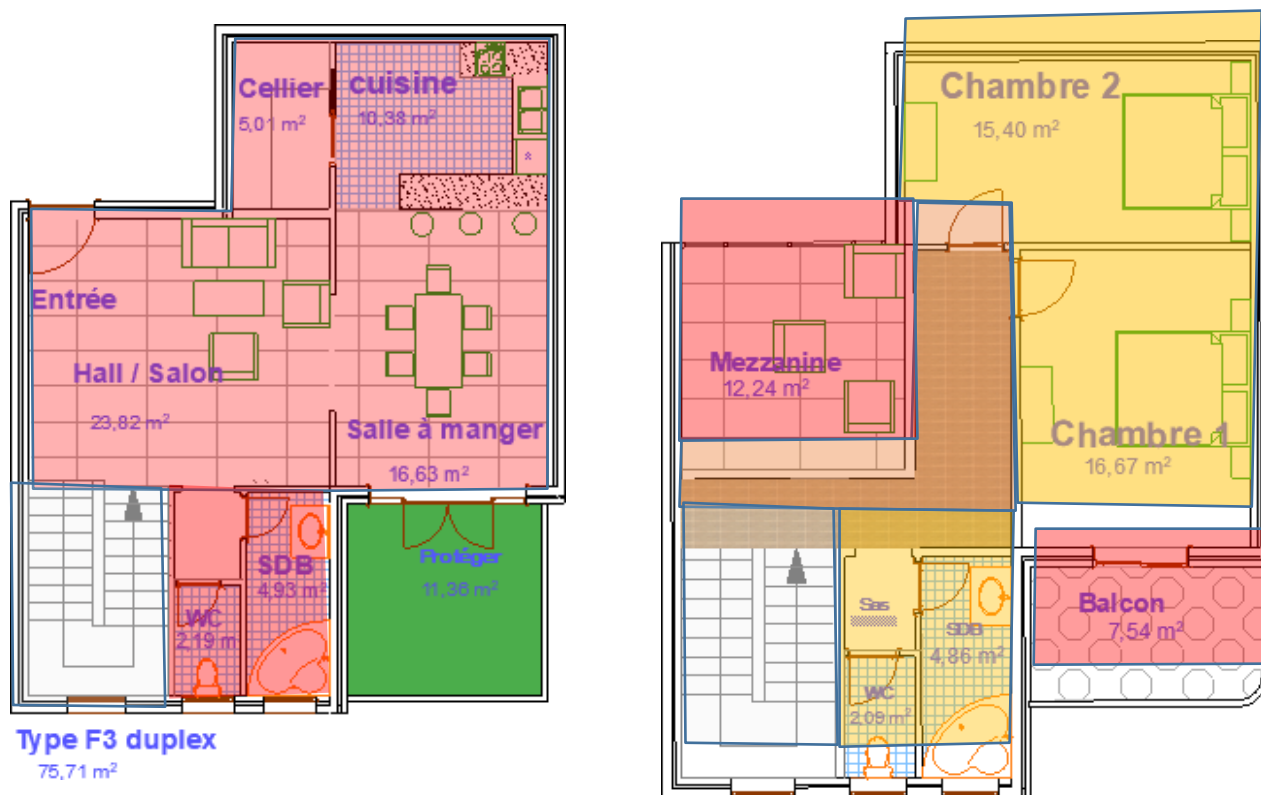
plan d'habitat semi collectif type F3 duplex, source : auteur, 2024
